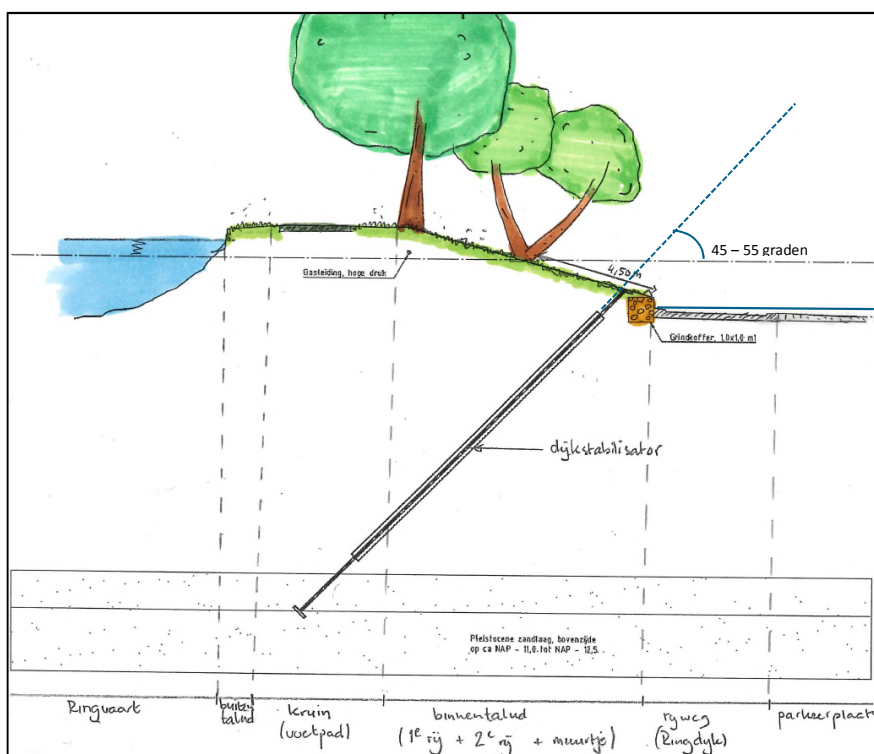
; globale ruimtelijke verdeling van het kadeprofiel
